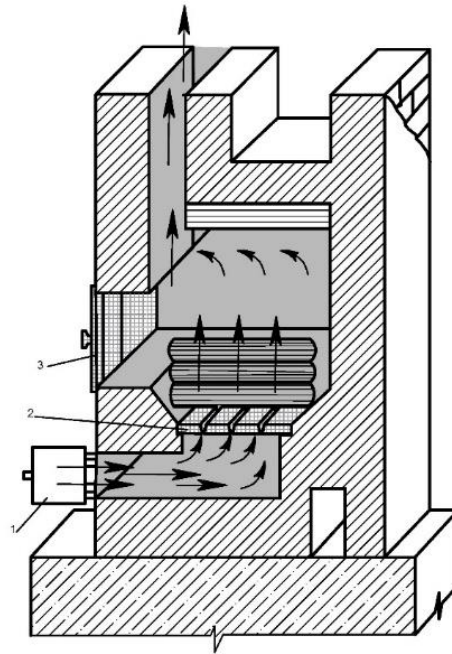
Схема движения воздуха в топливниках с колосниковой решёткой.
